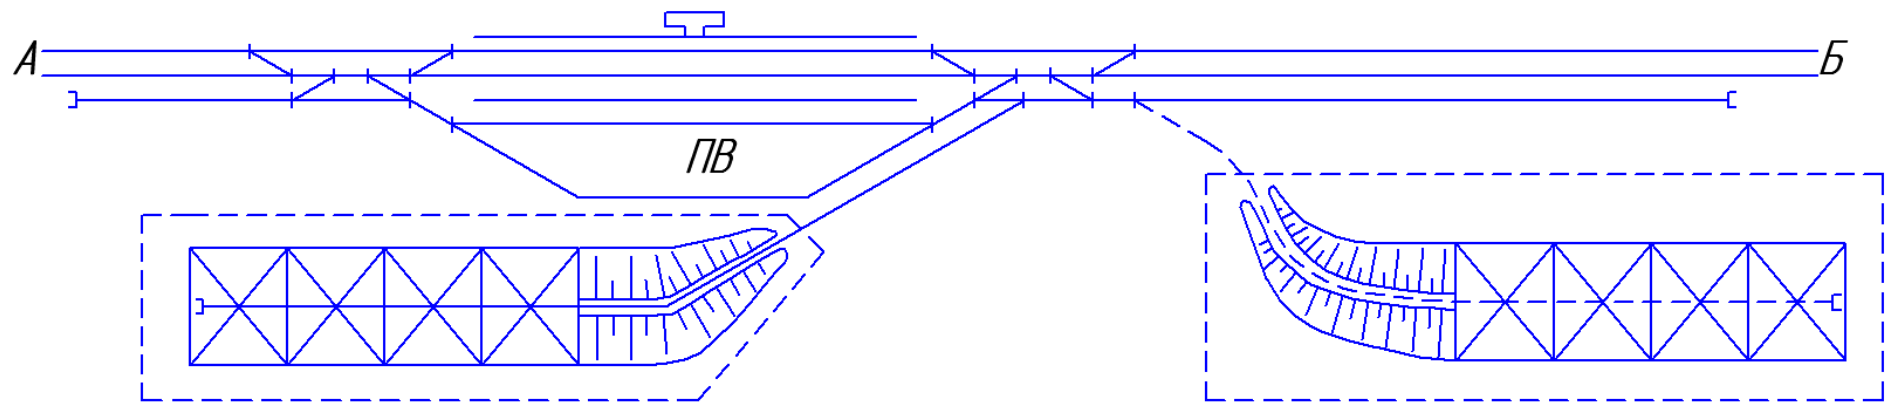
Схема ВС для переробки вагонів з мінерально-будівельними вантажами
